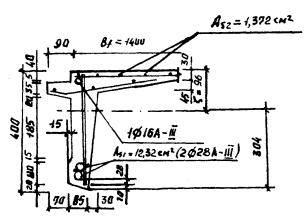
Расчетное пролетное сечение 2 верхиего пояса арочной двафрагмы
